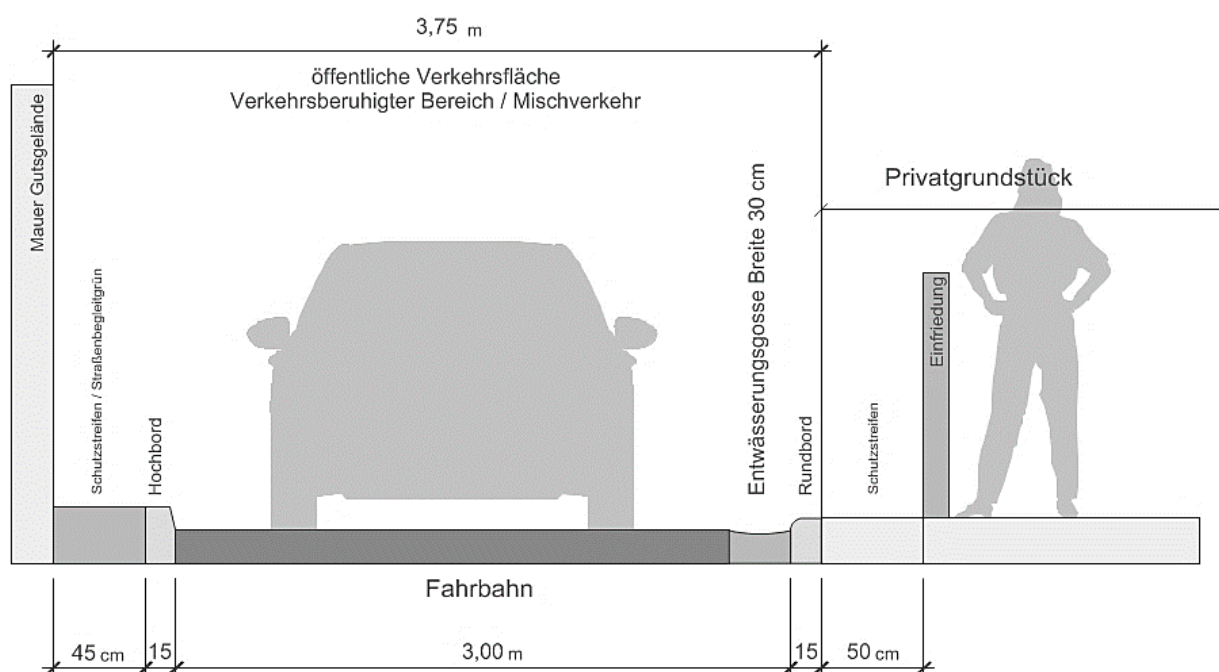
angedachter Straßenquerschnitt Teilstück Gutsanlage, Bereich Mauer
